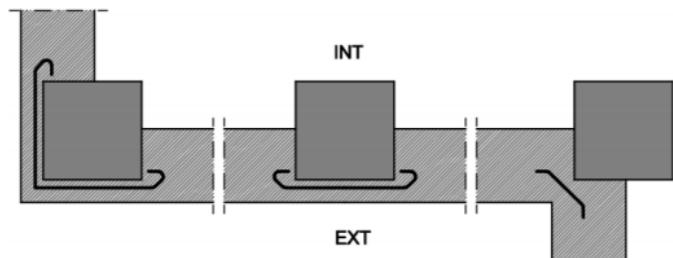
Ejemplo de encuentro de la fachada con los pilares
